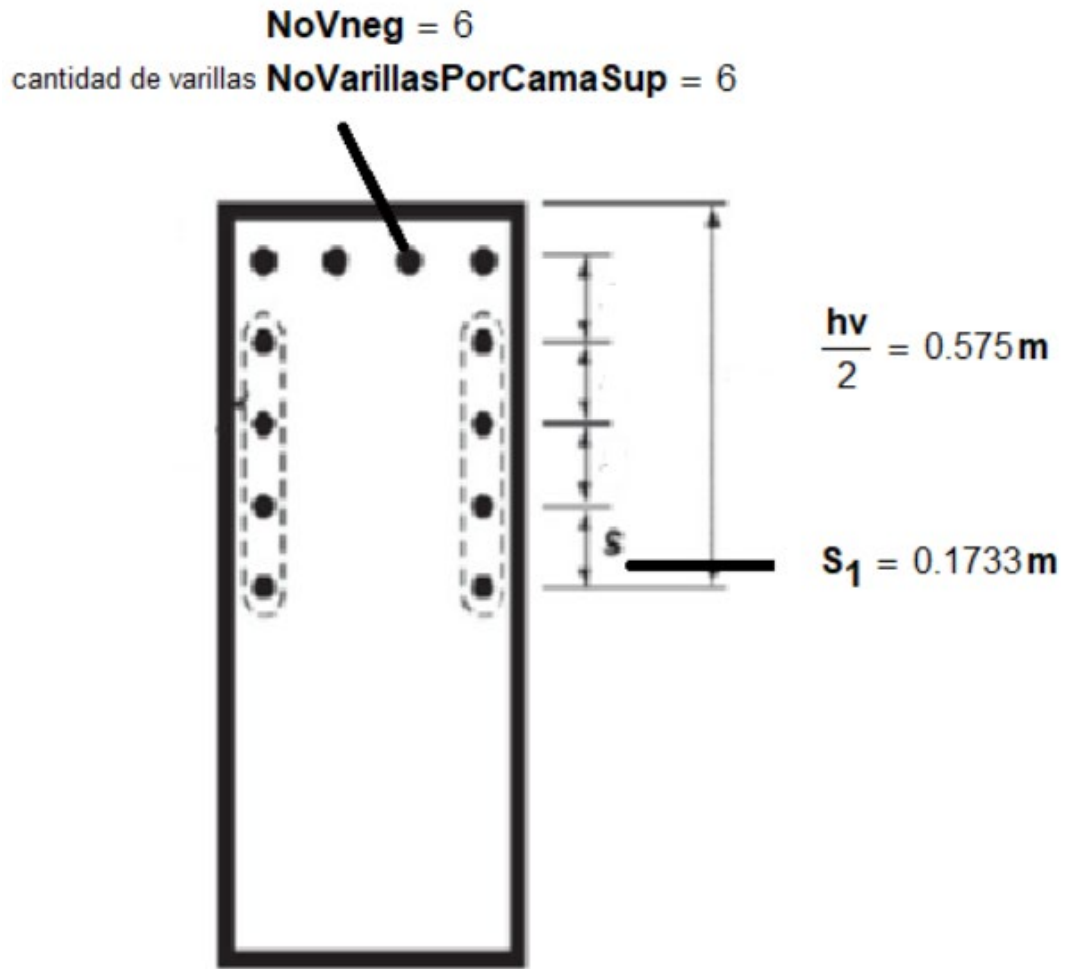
Detalle de refuerzo longitudinal inferior viga de acople, ejemplar uno
